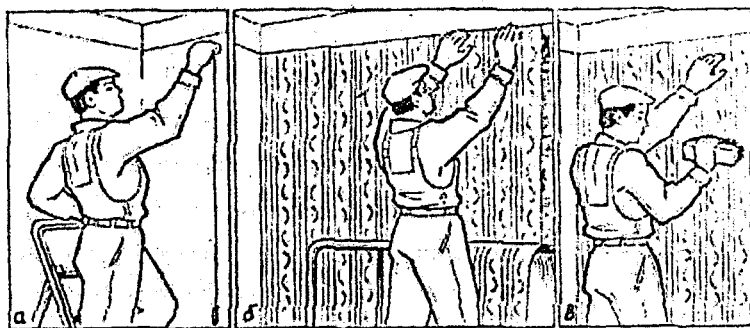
Наклеювання шпалер: а - розмічання під перше полотнище; б - наклеювання полотнищ; в - розгладжування щойно наклеєних шпалер за допомогою щітки
